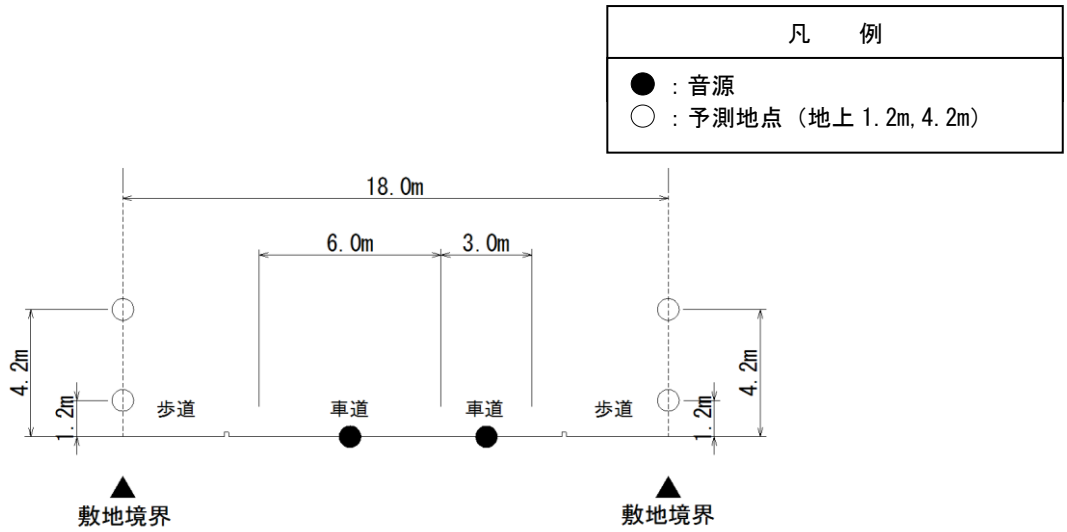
(4) 予測断面図 (D. 市川柏線)
